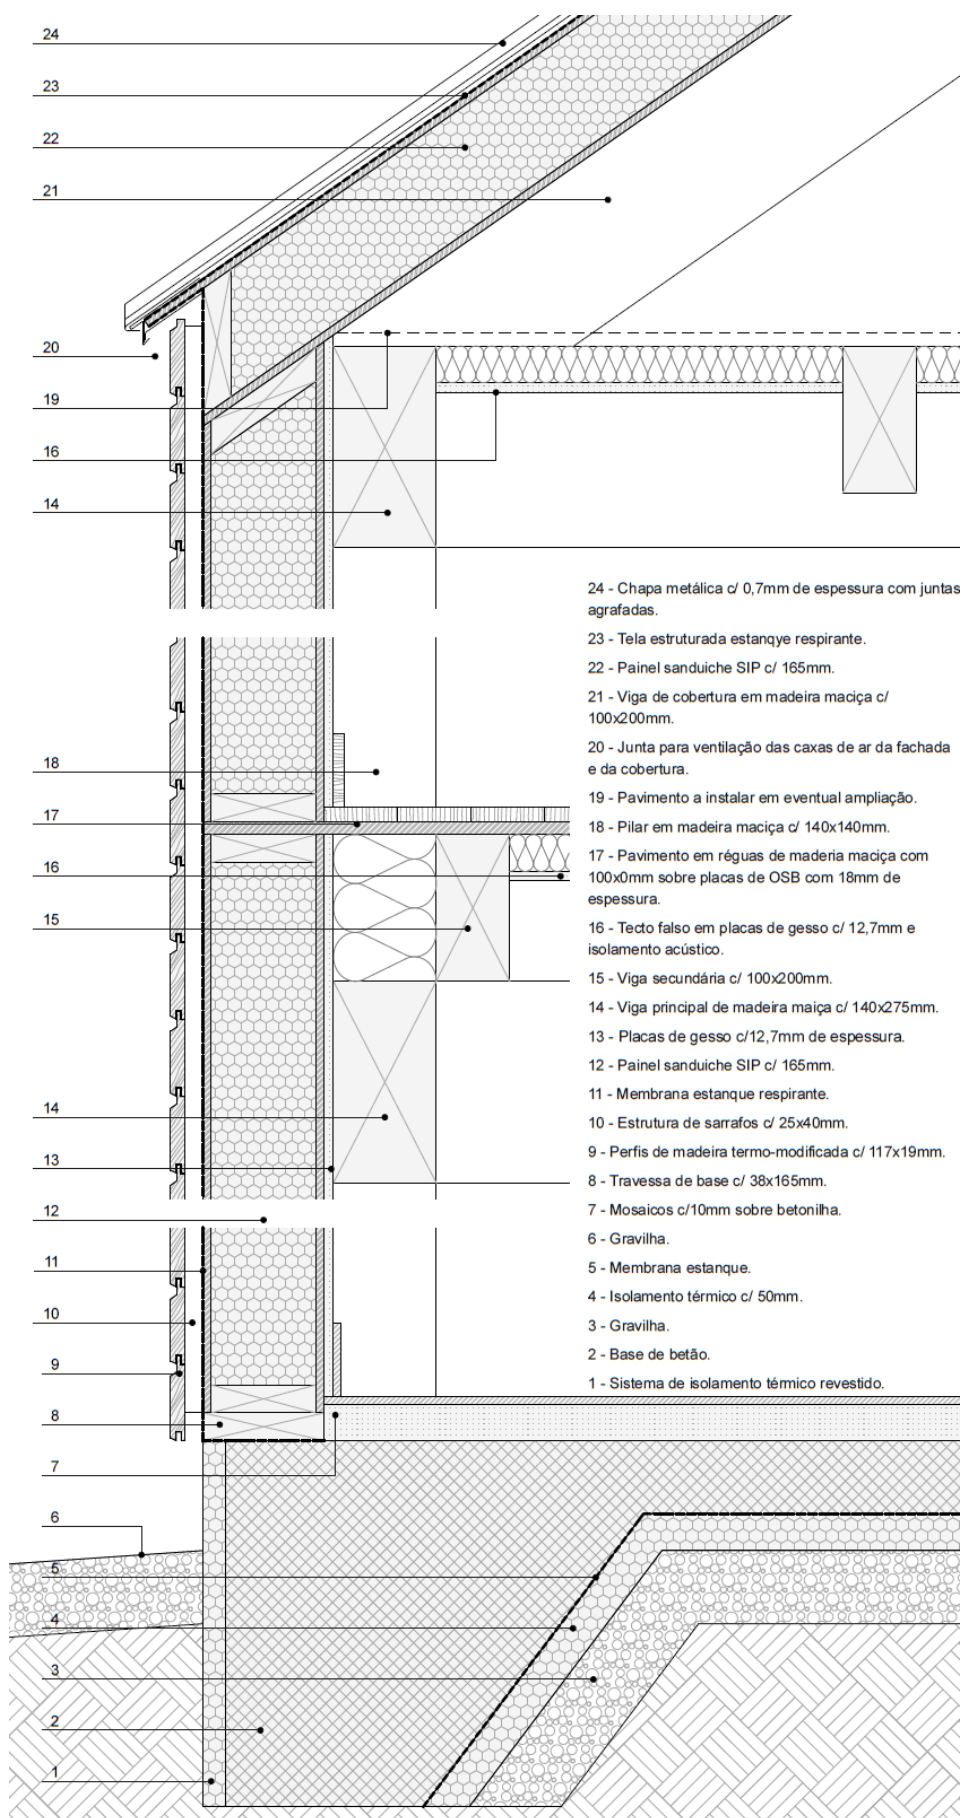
Corte construtivo pela fachada da solução de porticados, com envolvente em painéis sanduiche SIP.
